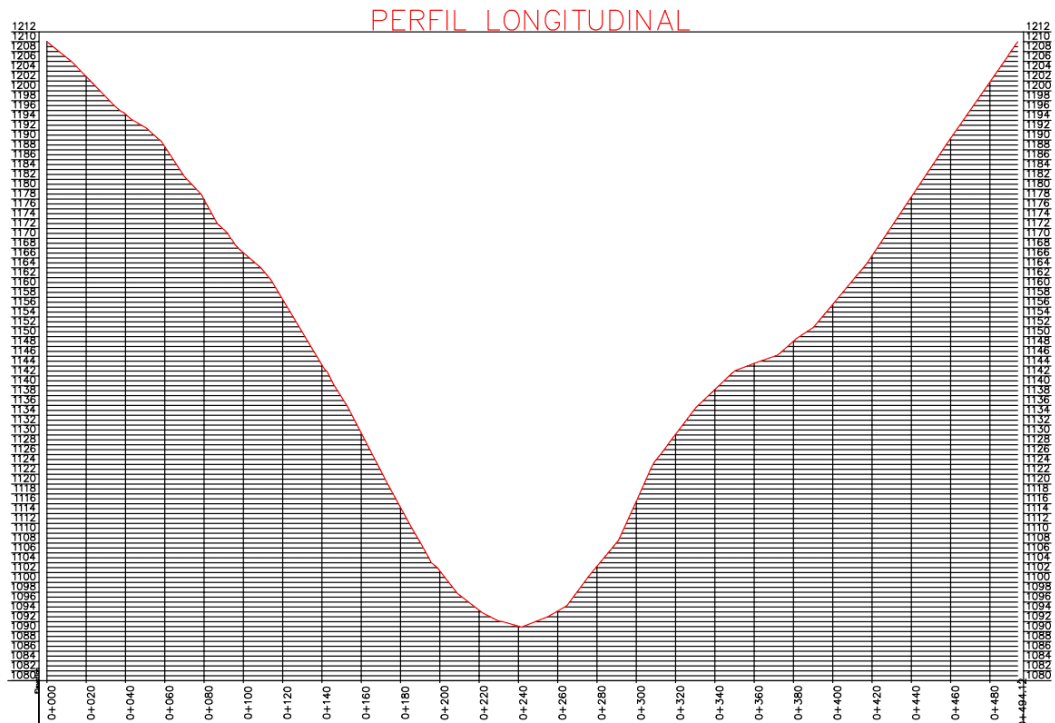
Perfil longitudinal del eje de emplazamiento La Tranca, Civil 3D
